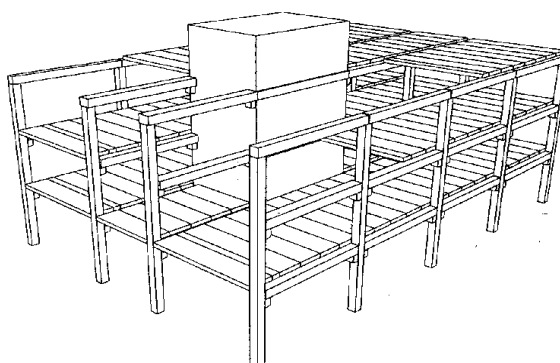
16 – Núcleo rígido central em uma estrutura do tipo esqueleto (FONTE: Ferreira, 2008).
